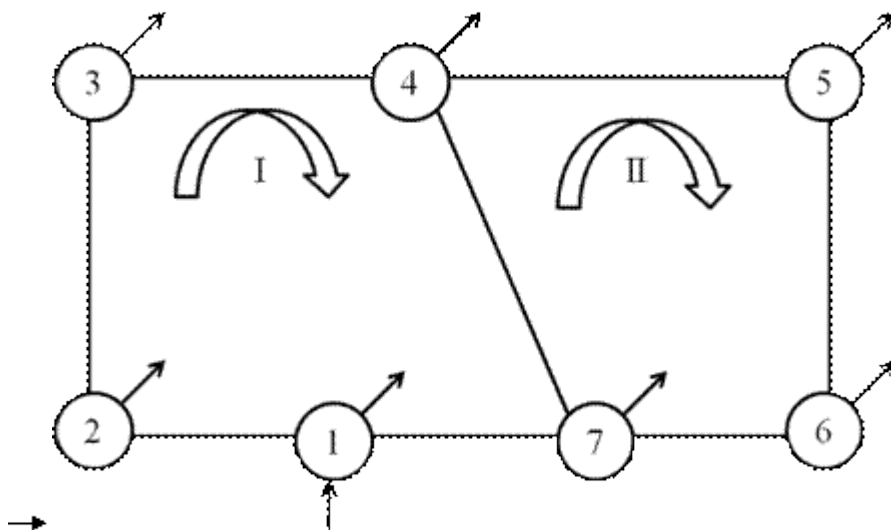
Расчетная схема водопроводной сети с предварительно распределенными расходами при пожаре
